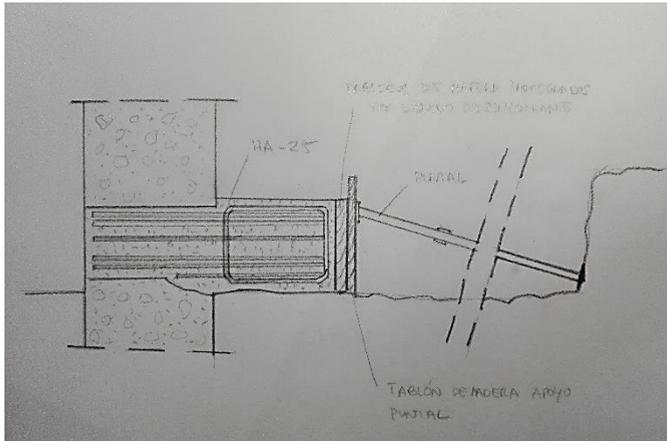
Detalle encofrado de los recalces de cimentación Nave 1. Figuras propias 2016.
